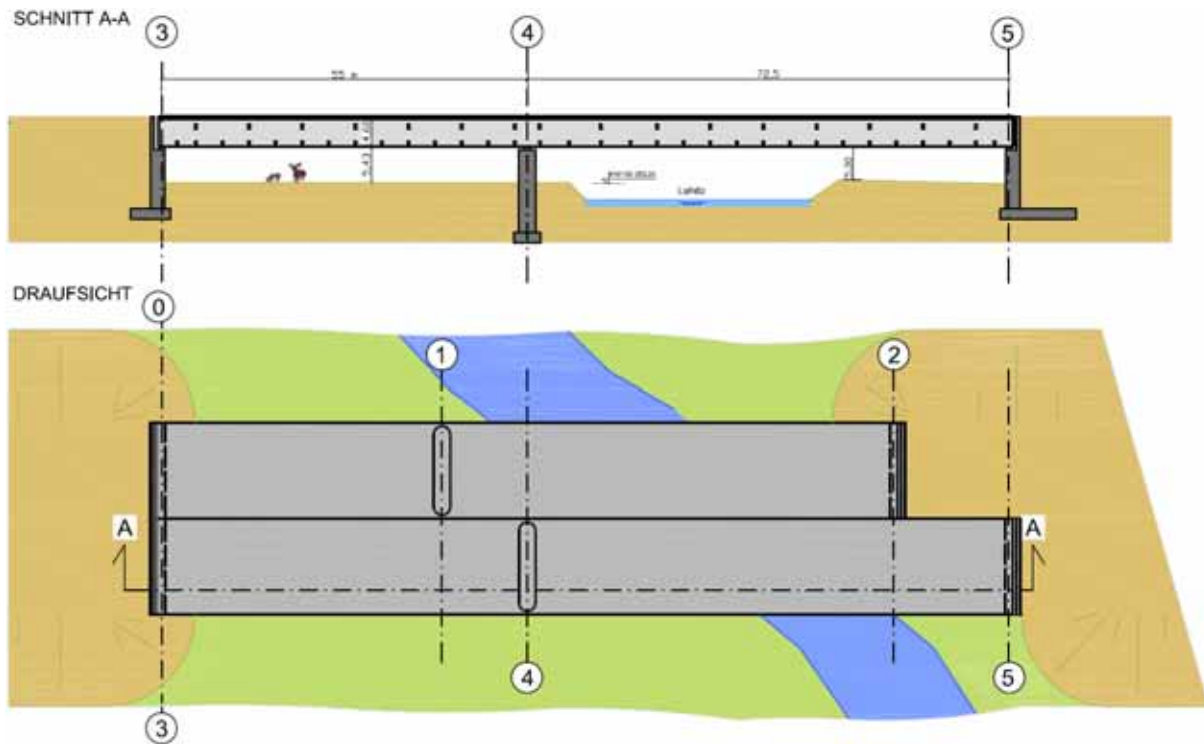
Stahl - Beton – Verbundbrücke zur Überführung der S7 über die Lafnitz und Feuchtsenken (Planung: Schimetta Consult GmbH)
